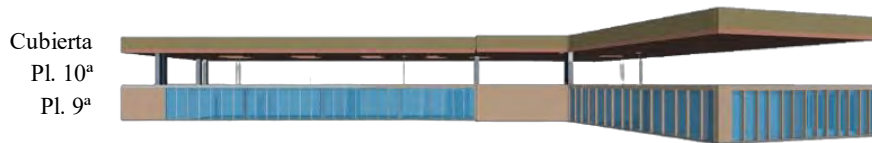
Detalle del diseño de la planta y la cubierta, en BIMserver.center.
